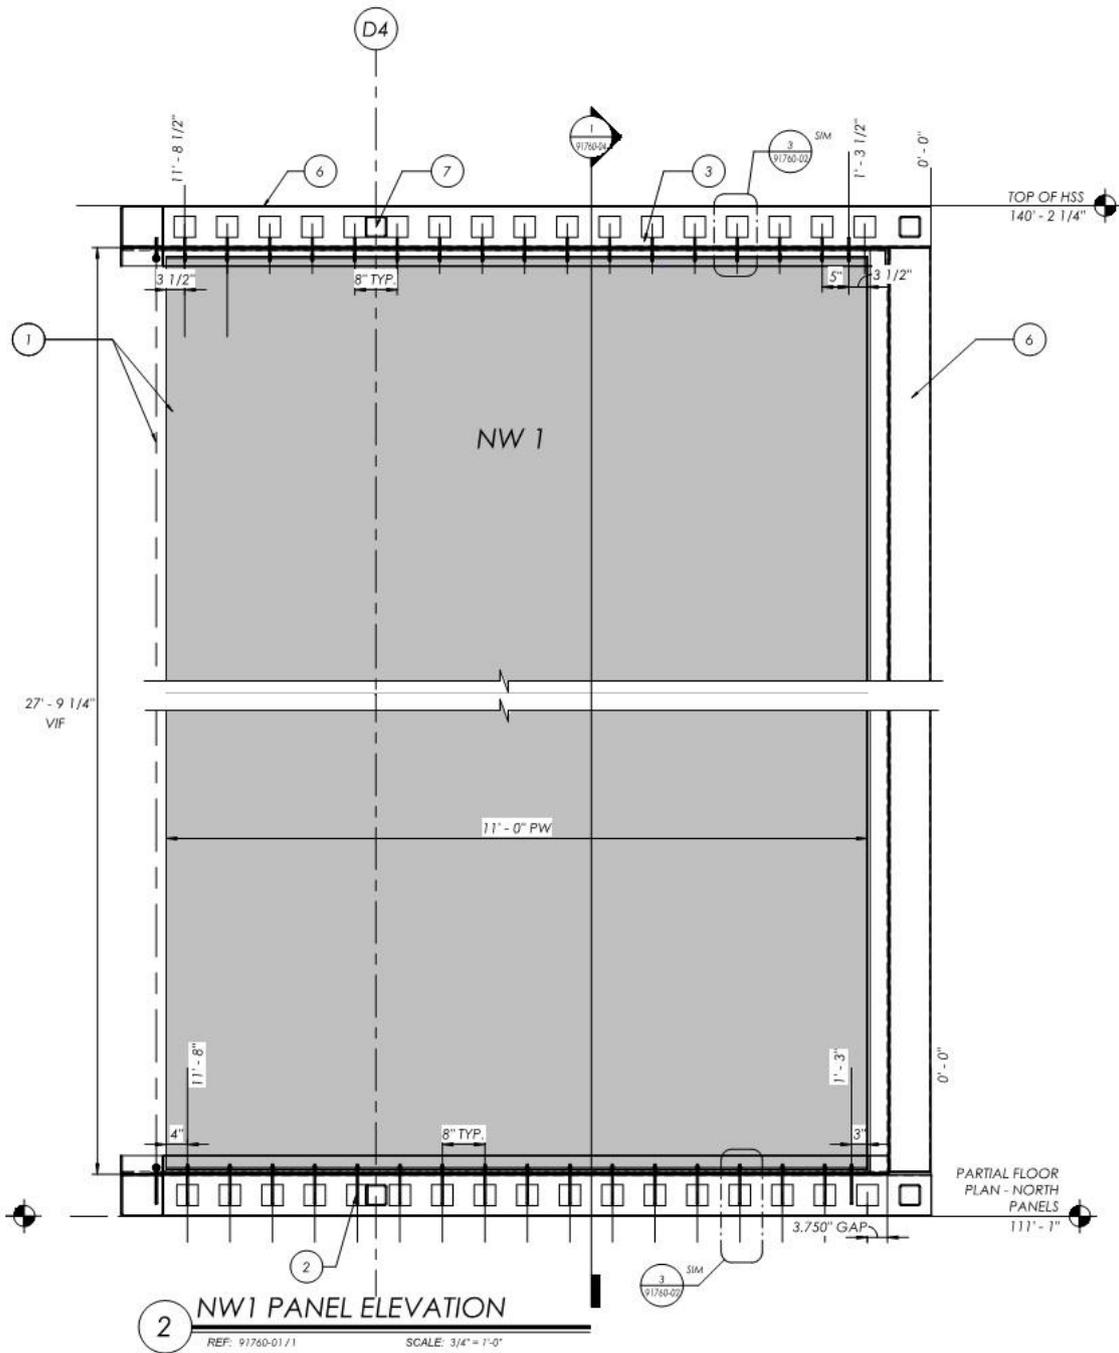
Elevación del panel orientado hacia el Noroeste
